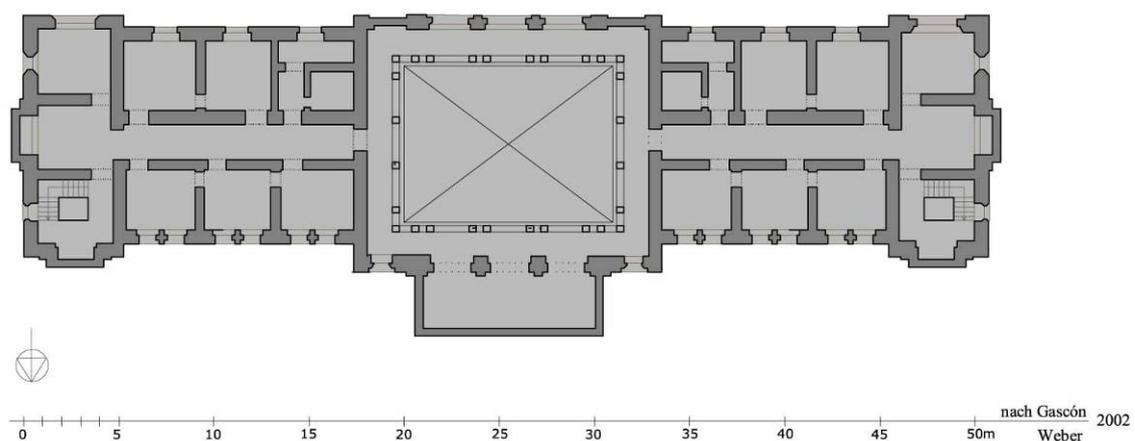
Hedschasbahnhof [44], Grundriss OG
